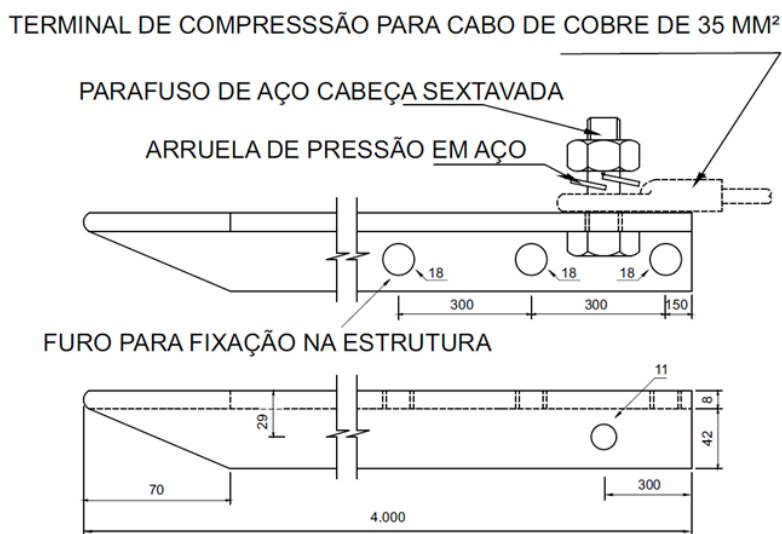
Detalhe construtivo da haste cantoneira para o sistema de captação do SPDA.
